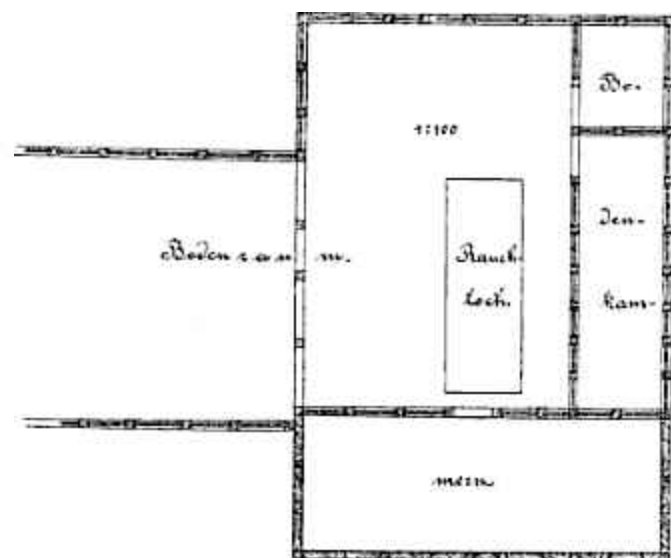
, 9 und 10. Grundrisse eines ermländischen Bauernhauses (Kresfeld).
